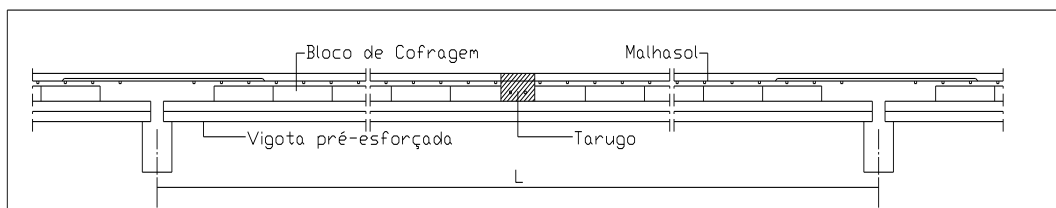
Corte longitudinal tipo de uma laje aligeirada de vigotas pré-esforçadas FAPREL
